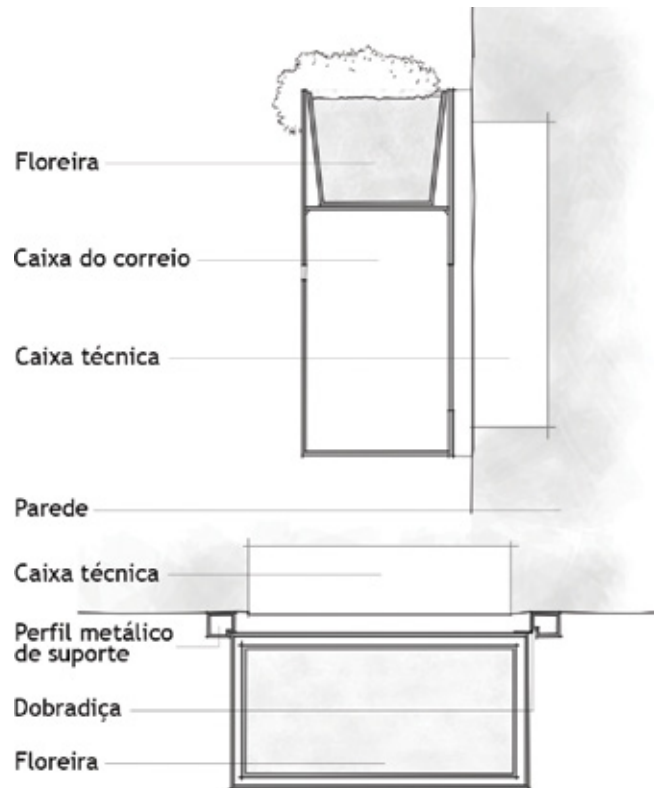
Corte e planta de elemento de dissimulação de caixas técnicas (sem escala)
